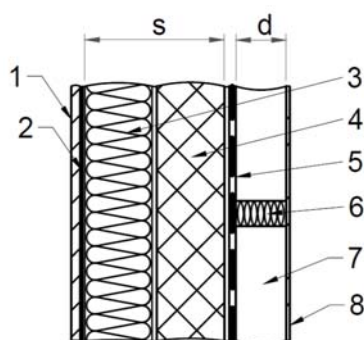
Schalldämmung mit Luftspalt; Schallentkoppelte Ausführung der Stützkonstruktion
